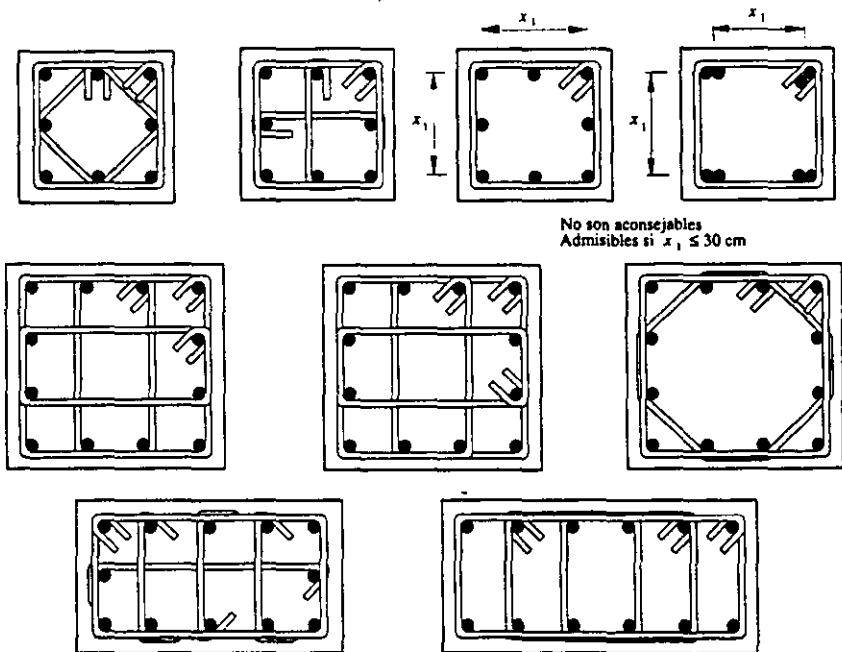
Arreglos admisibles de refuerzo en columnas de marco dúctiles de concreto
